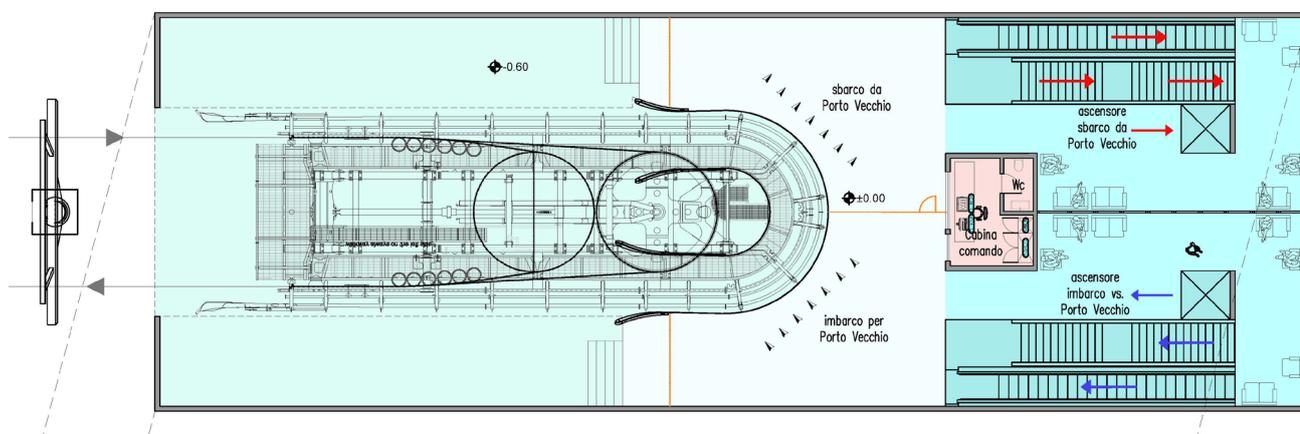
Planimetria piano primo stazione terminale di "Trieste".
